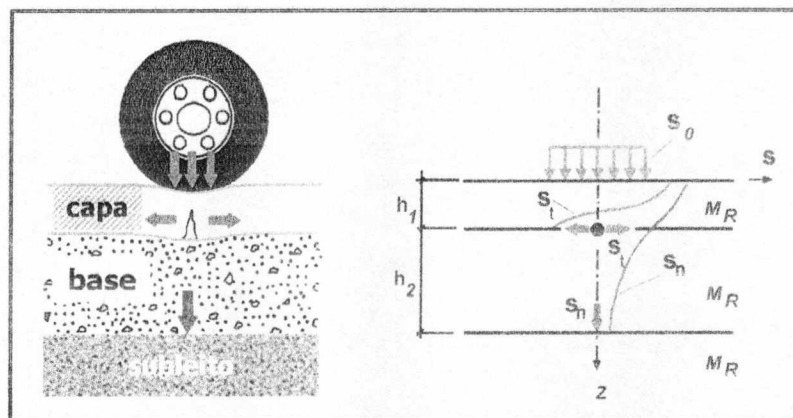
Ação da carga nos pontos críticos das camadas do pavimento
